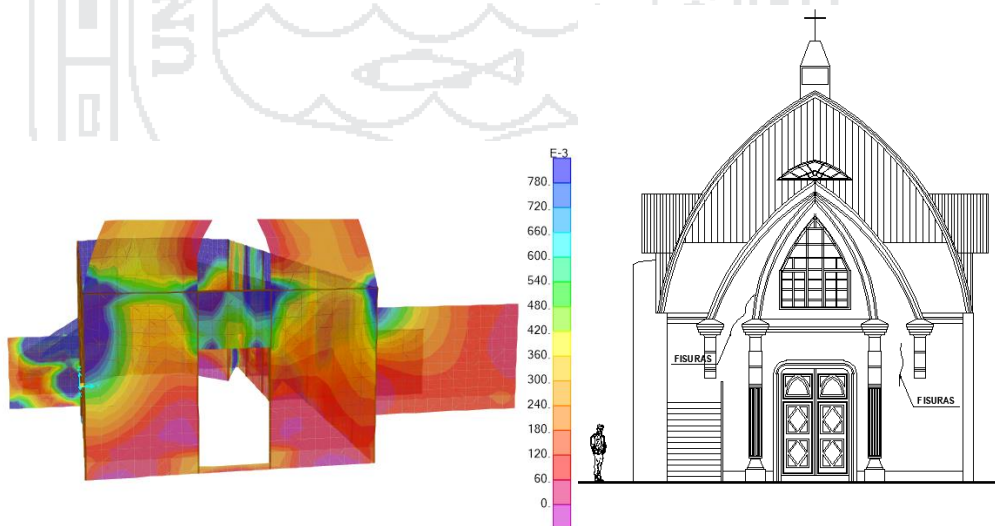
Grietas formadas a causa de esfuerzos a flexión en muro frontal.
